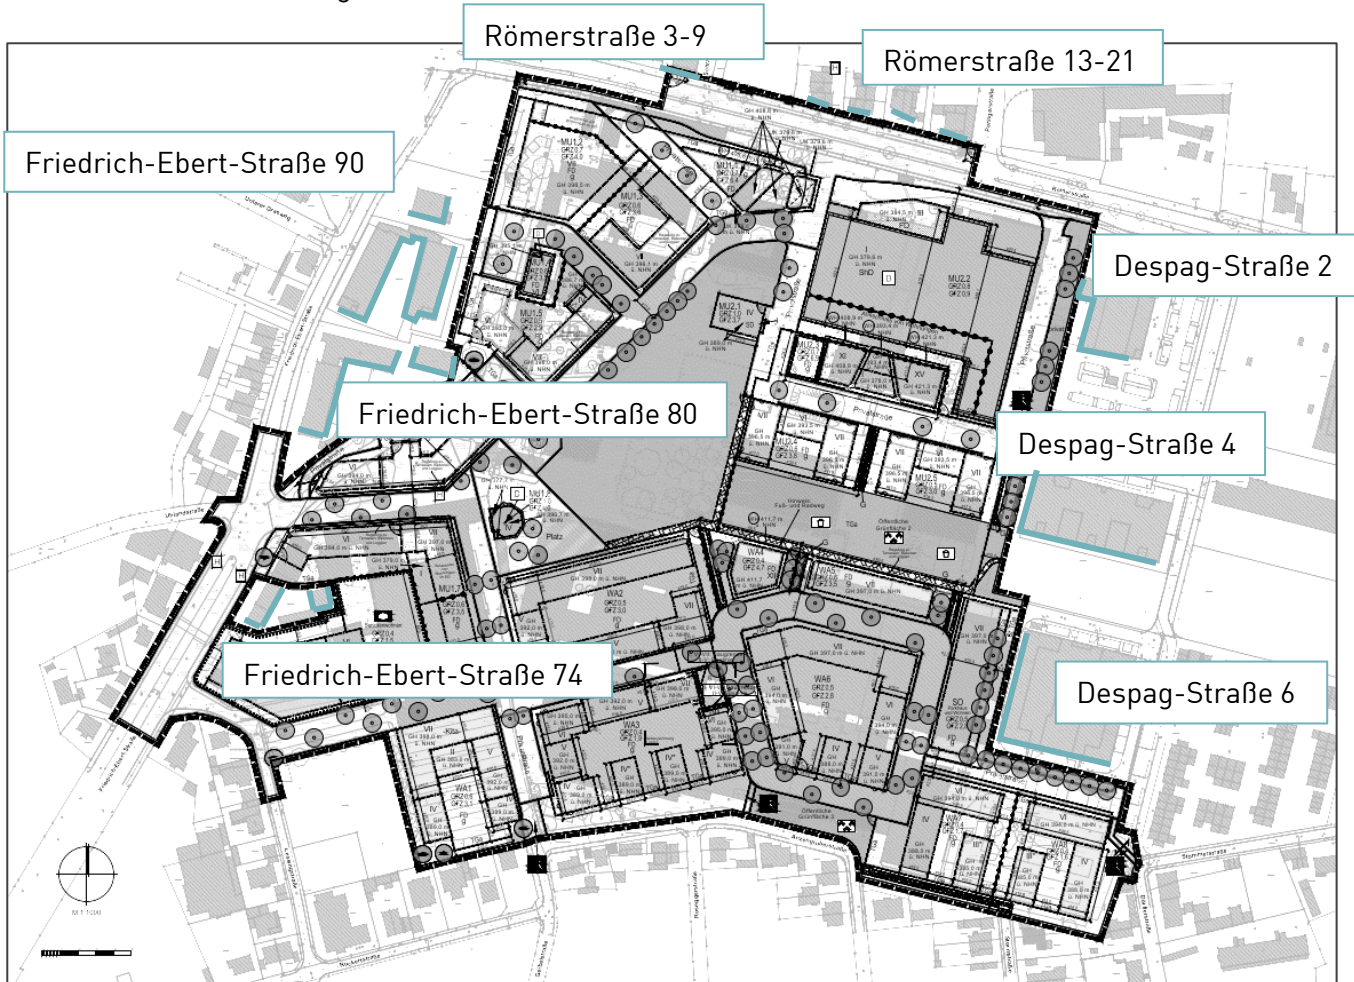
Bebauungsplan – Übersicht Baufelder (Quelle: Stadtplanung Zimmermann GmbH)
